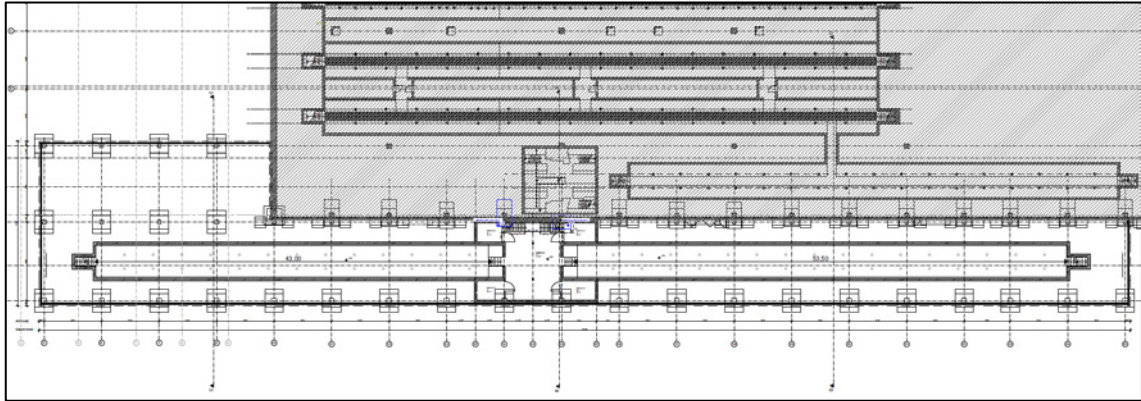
Grundriss Untergeschoss/Wartungsgrube [2.a]
